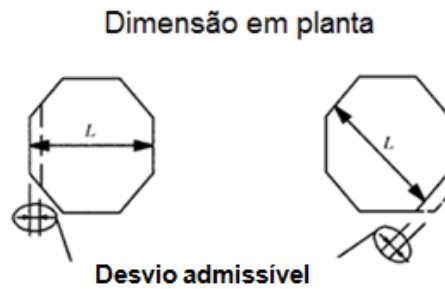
Cofragem de fundação: dimensões da secção transversal (adaptado da Fig. R3.5.1 [11]).
